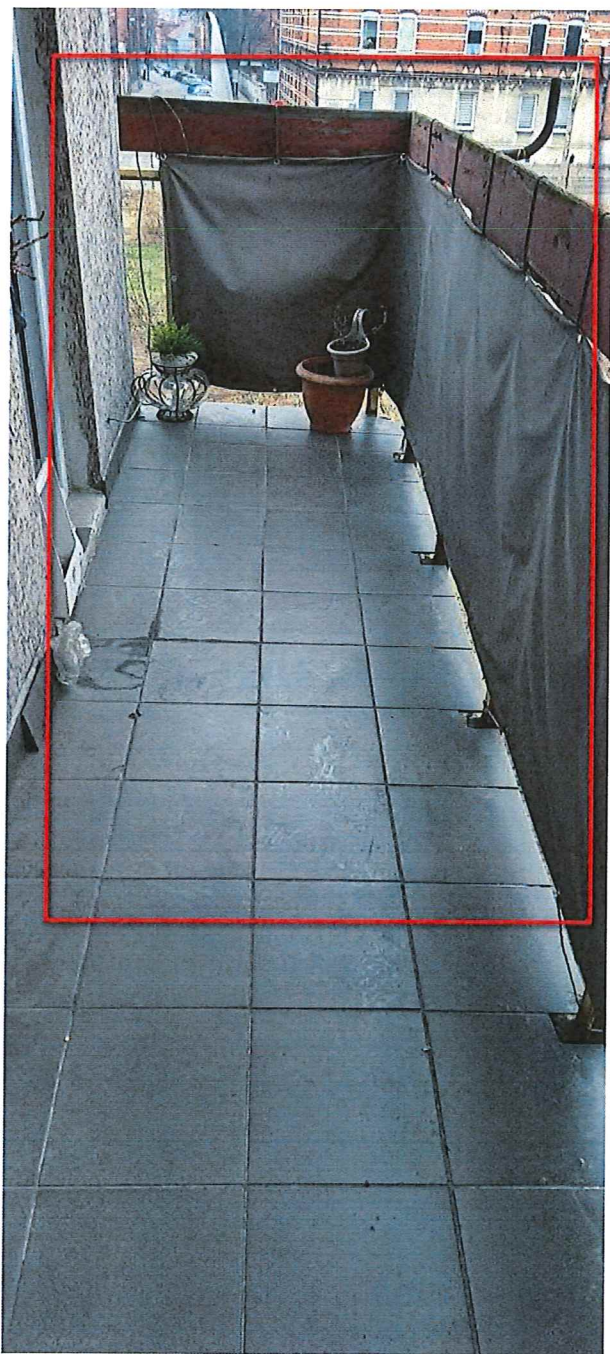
Elewacja tylna– widok balkonów do remontu.
